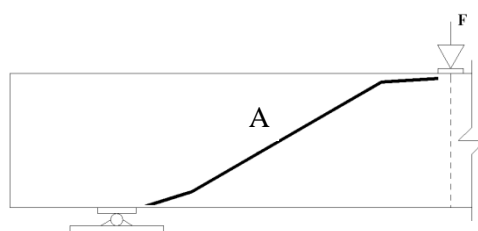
Esquema da fissura diagonal crítica.
